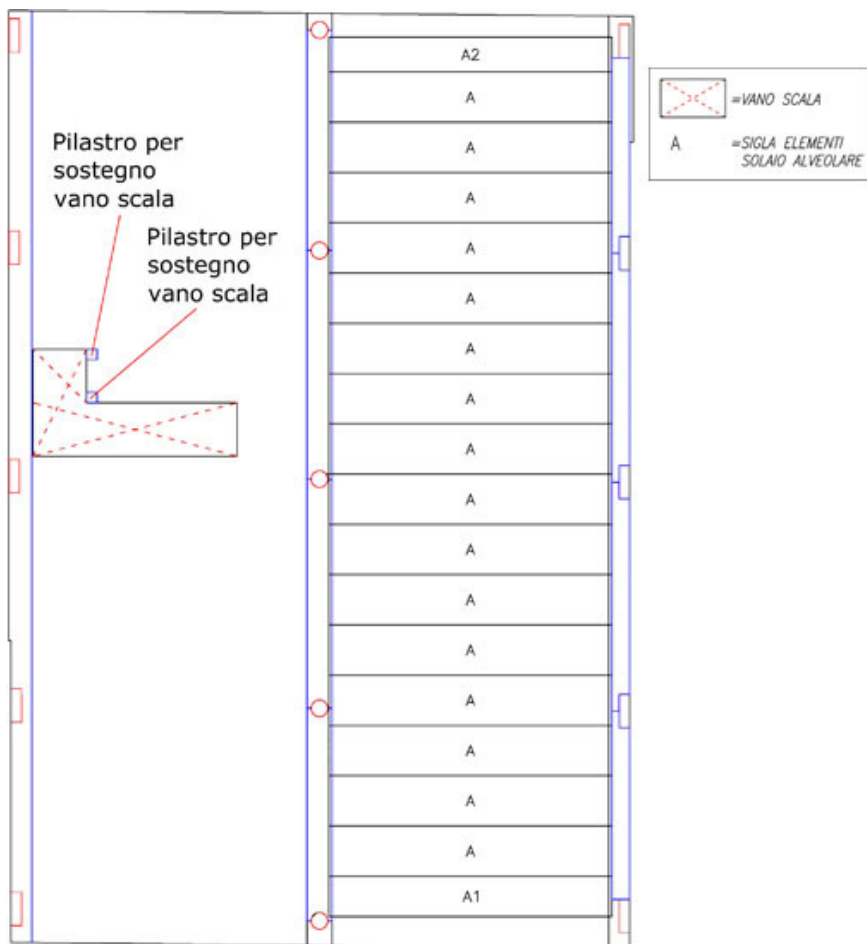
Solaio piano primo. Il solaio è realizzato in due diverse soluzioni prefabbricate: la parte destra è stata realizzata con un solaio alveolare, a sinistra, invece, con pannelli Wood Beton Prepanel® Evoluzione.
